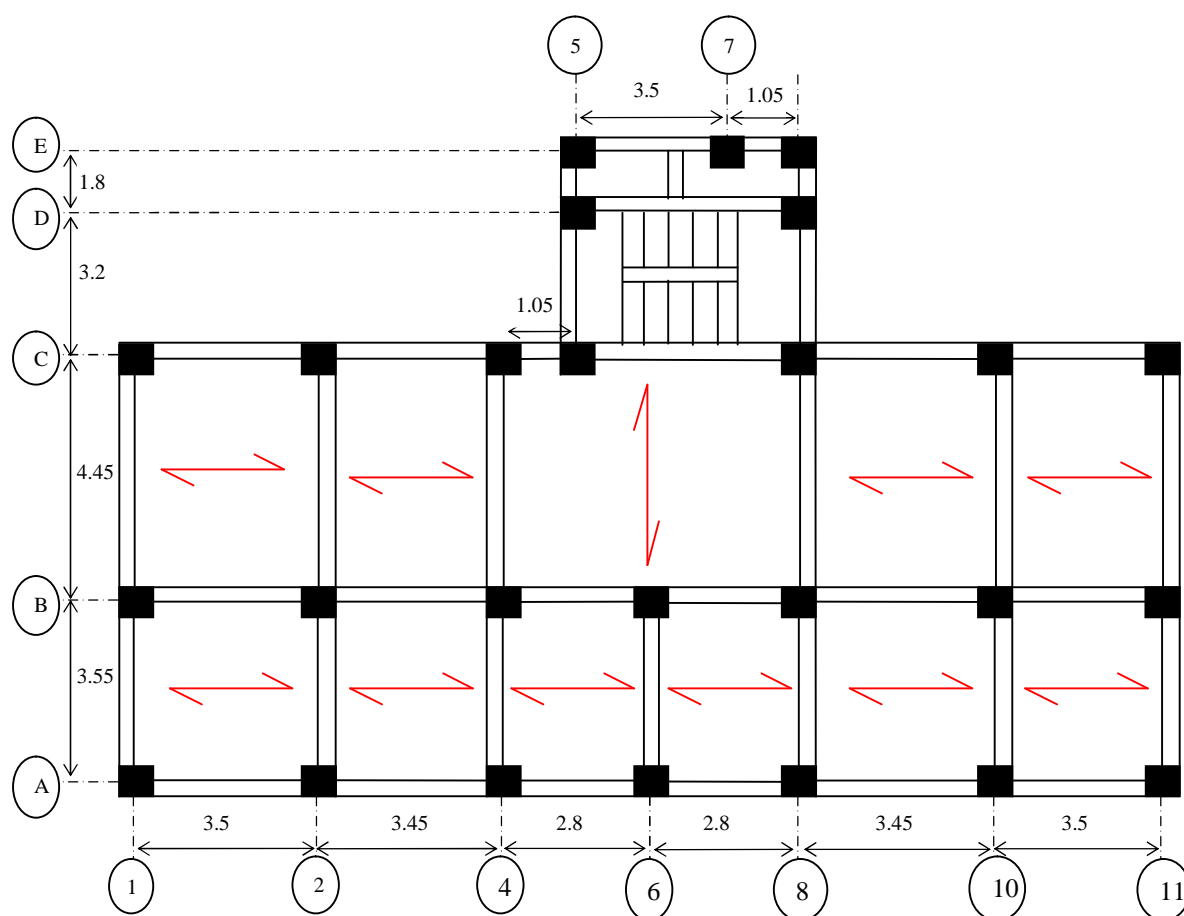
Sens de disposition des poutrelles du RDC au 4^{ème} étage.
